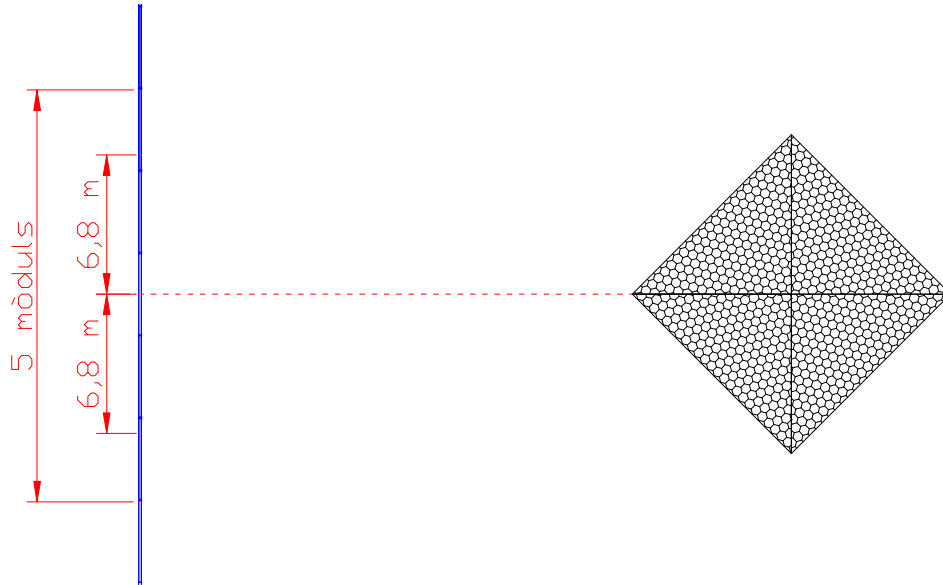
Croquis vista planta situació pantalla respecte R5.
